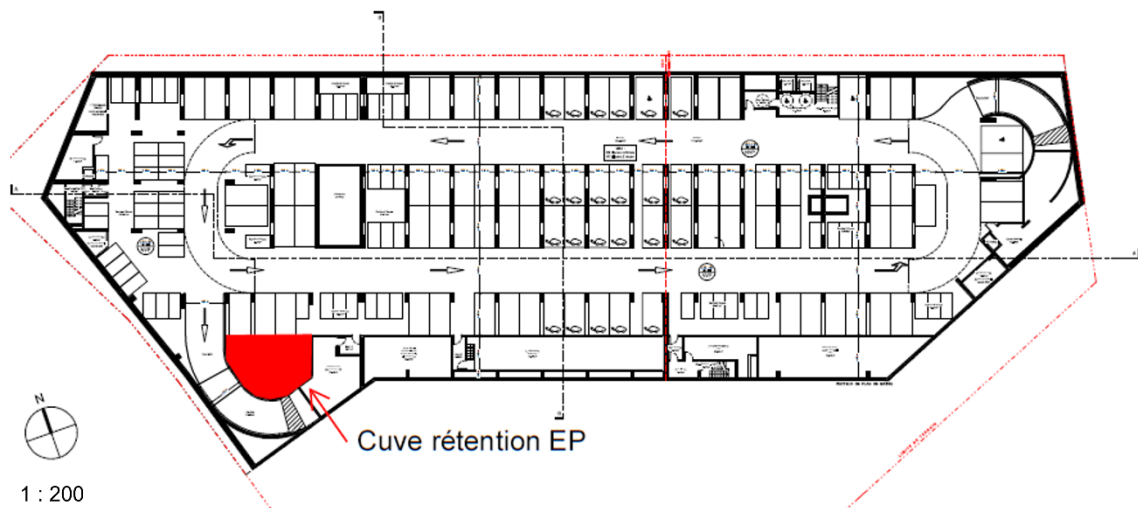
Plan du niveau M03 – Localisation de la cuve de rétention des eaux pluviales (Source : groupement, Cabinet Viguiier, 31/01/2023)
